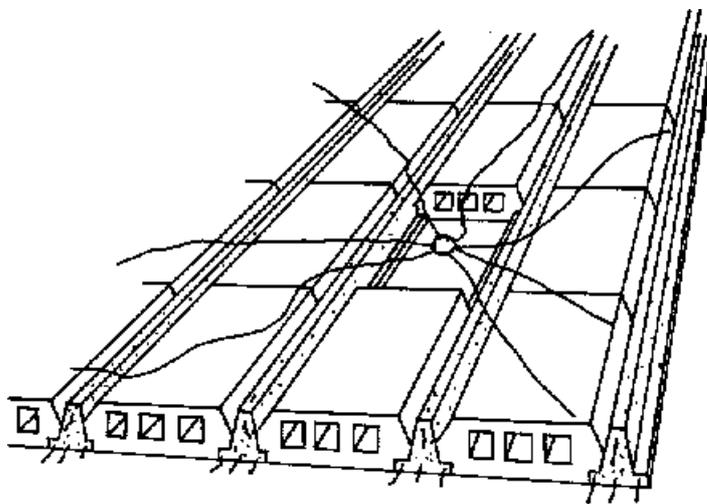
Disposição dos elementos estruturas de lajes pré - moldadas [6].
